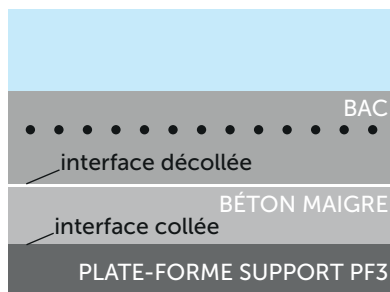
Structure BAC classique (BAC/ Béton maigre) avec collage entre fondation et plate-forme et décollément entre BAC et béton maigre.
